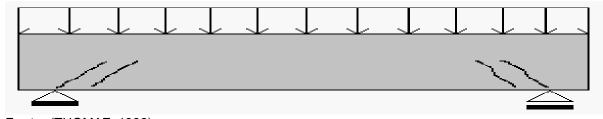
Trincas de flexão em elementos de concreto armado.
